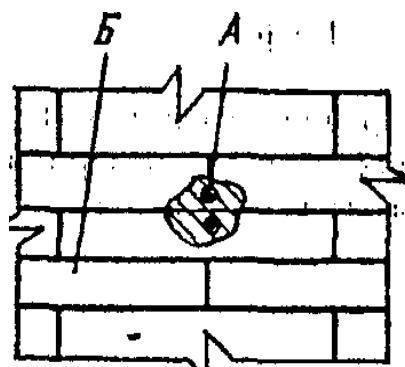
Коррозия А сварного шва, околошовной зоны, а также основного металла стенки Б на длине не более 500 мм.
